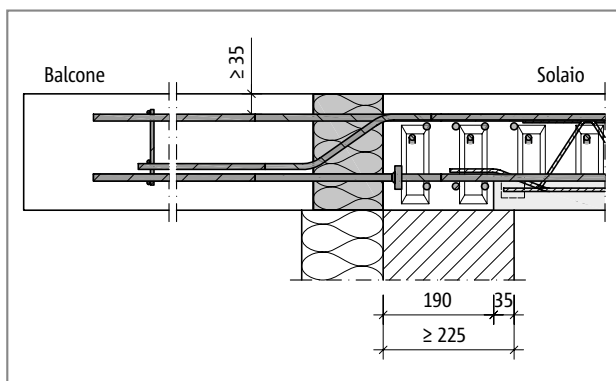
Schöck Isokorb® tipo EXT: soletta dell'elemento senza supporto sul bordo con cappotto (sezione EXT-L-CV35; vista EXT-R-CV50)
